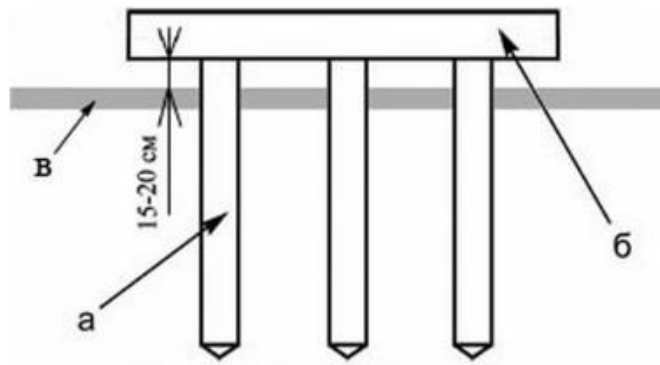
Пальовий фундамент: а – палі; б – ростверк; в – ґрунт
